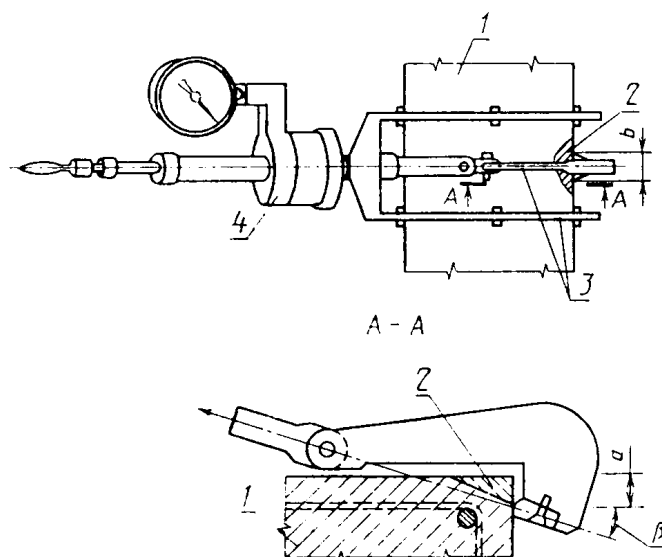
Схема испытания методом скалывания угла: 1 - испытуемая конструкция; 2 - скалываемый бетон; 3 - устройство УРС; 4 - прибор ГПНС-4
